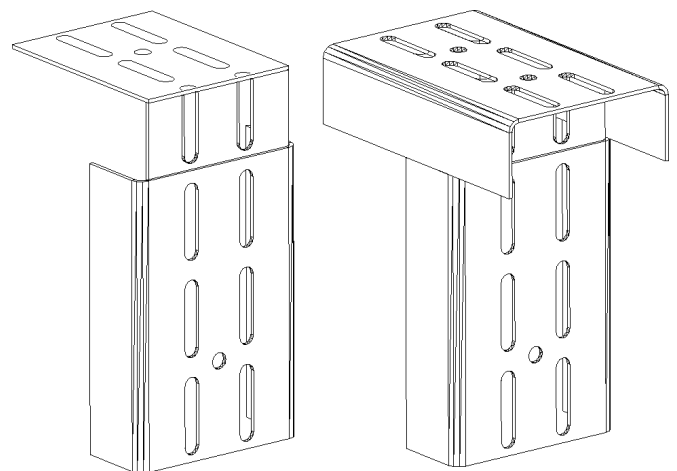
Perfil tipo UA con alas cortadas y alma doblada. Conexión con perfil UA de antepecho.
